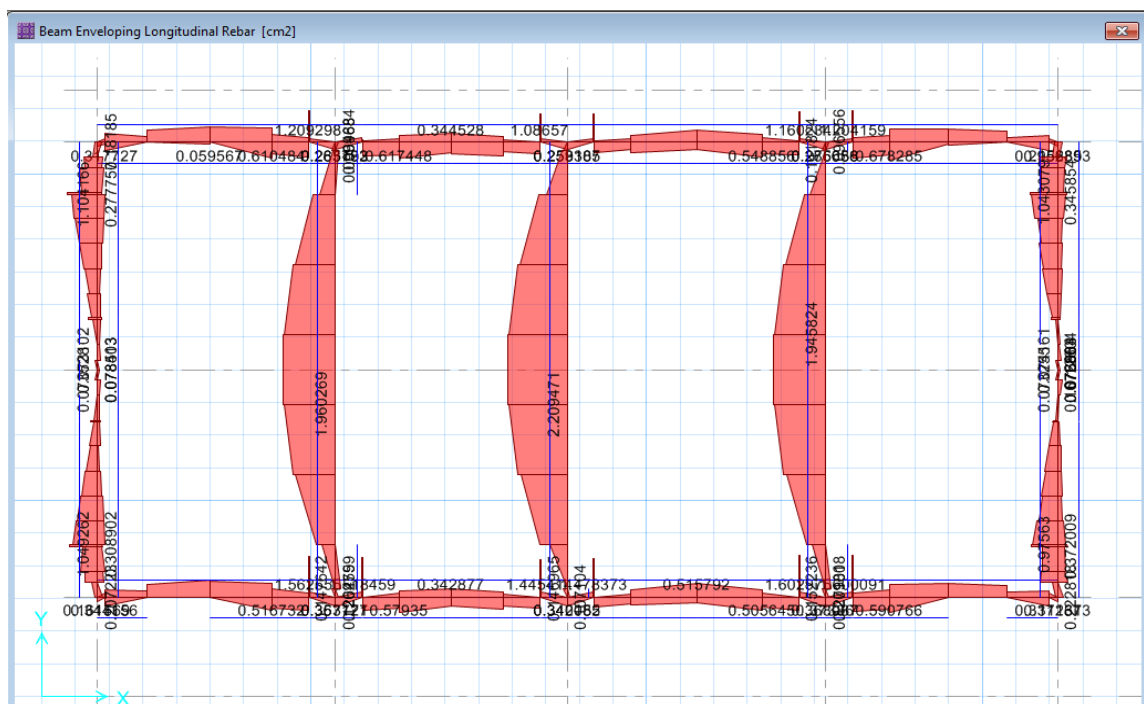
Refuerzo en cm2 de cimentación Módulo I
